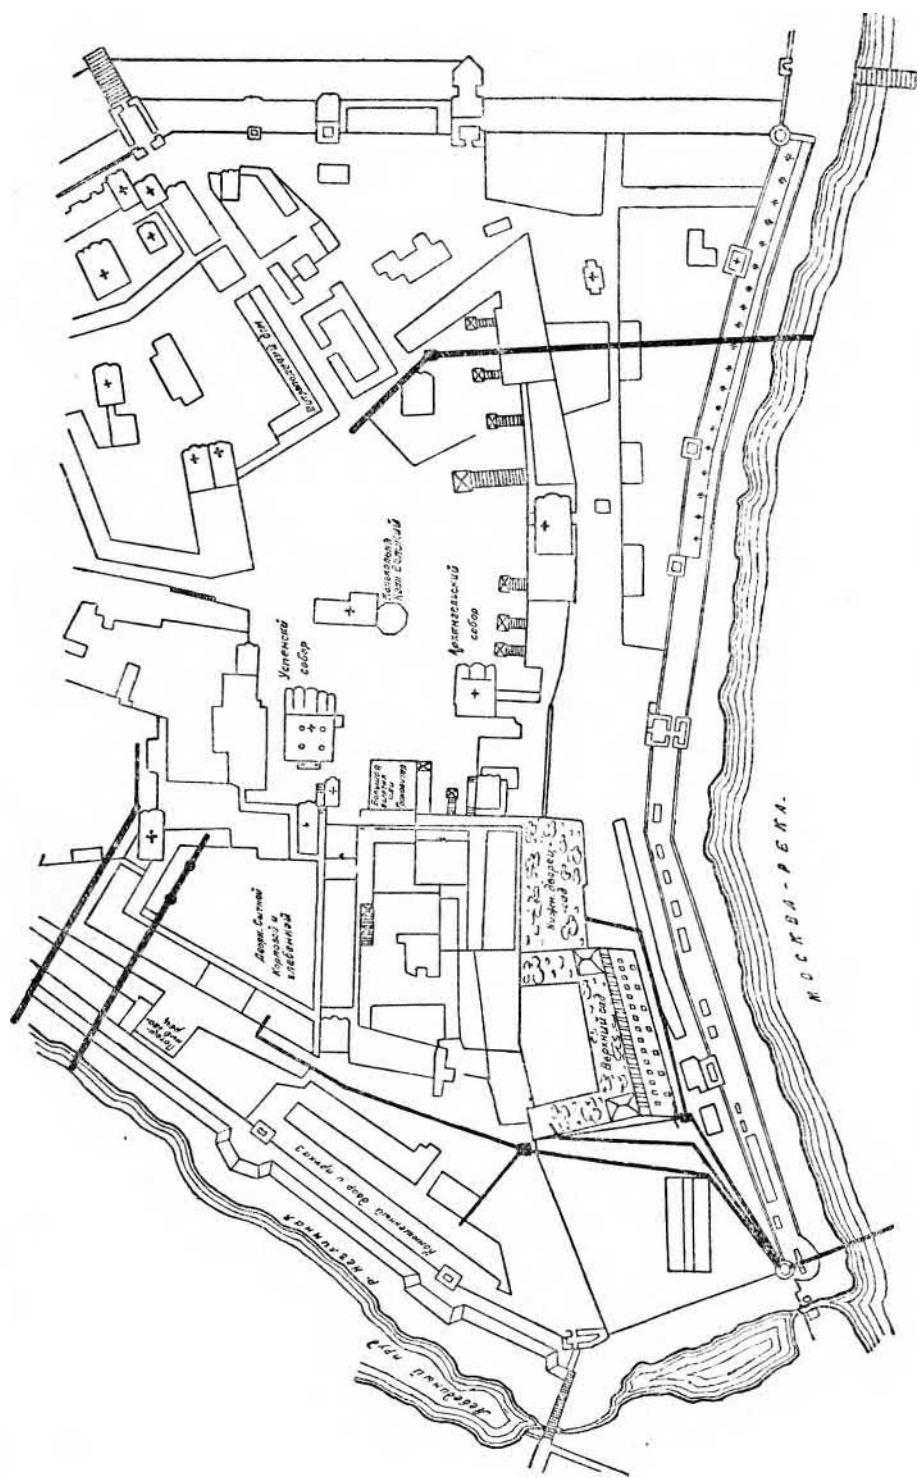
План части Кремля XVII в. с водопроводами и каналами (вариант реконструкции).
